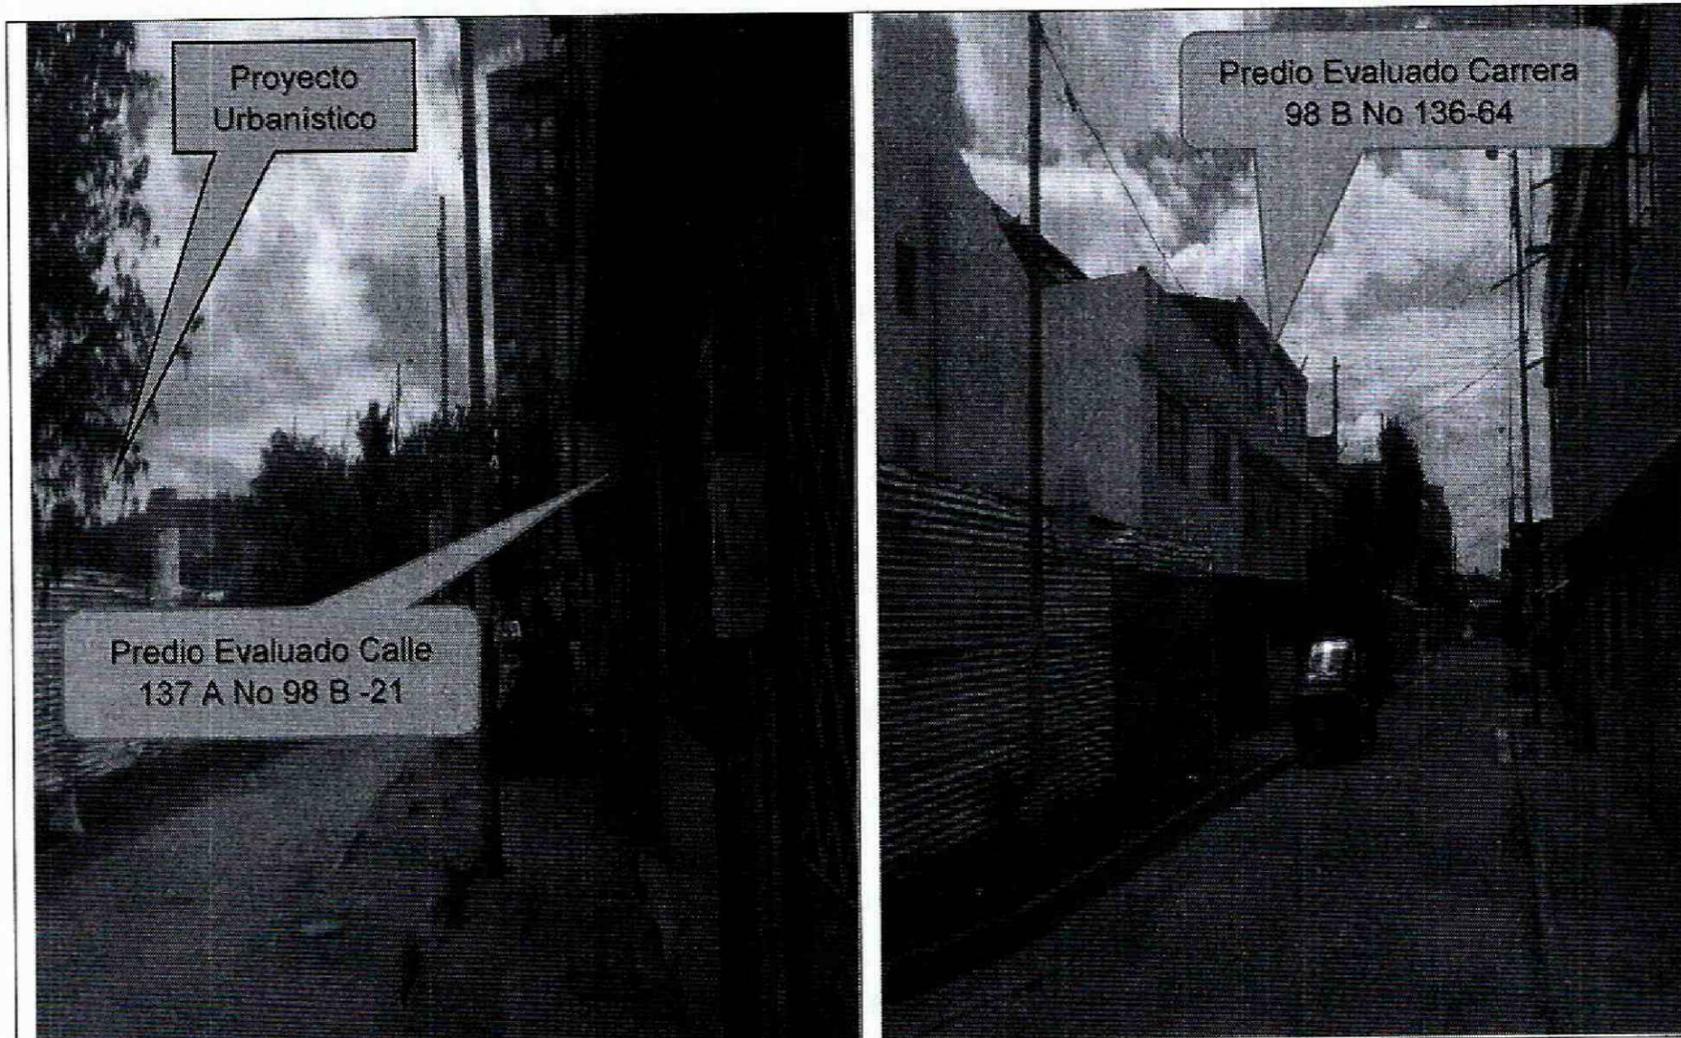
Vista general de la Calle 137ª, con tipología estructural de las viviendas ubicadas en el sector.
